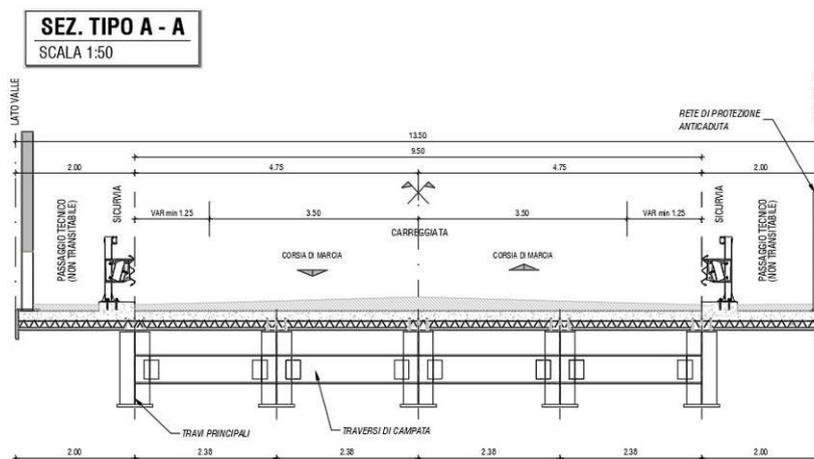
Sezione trasversale Ponte P01- su Canal Magro
